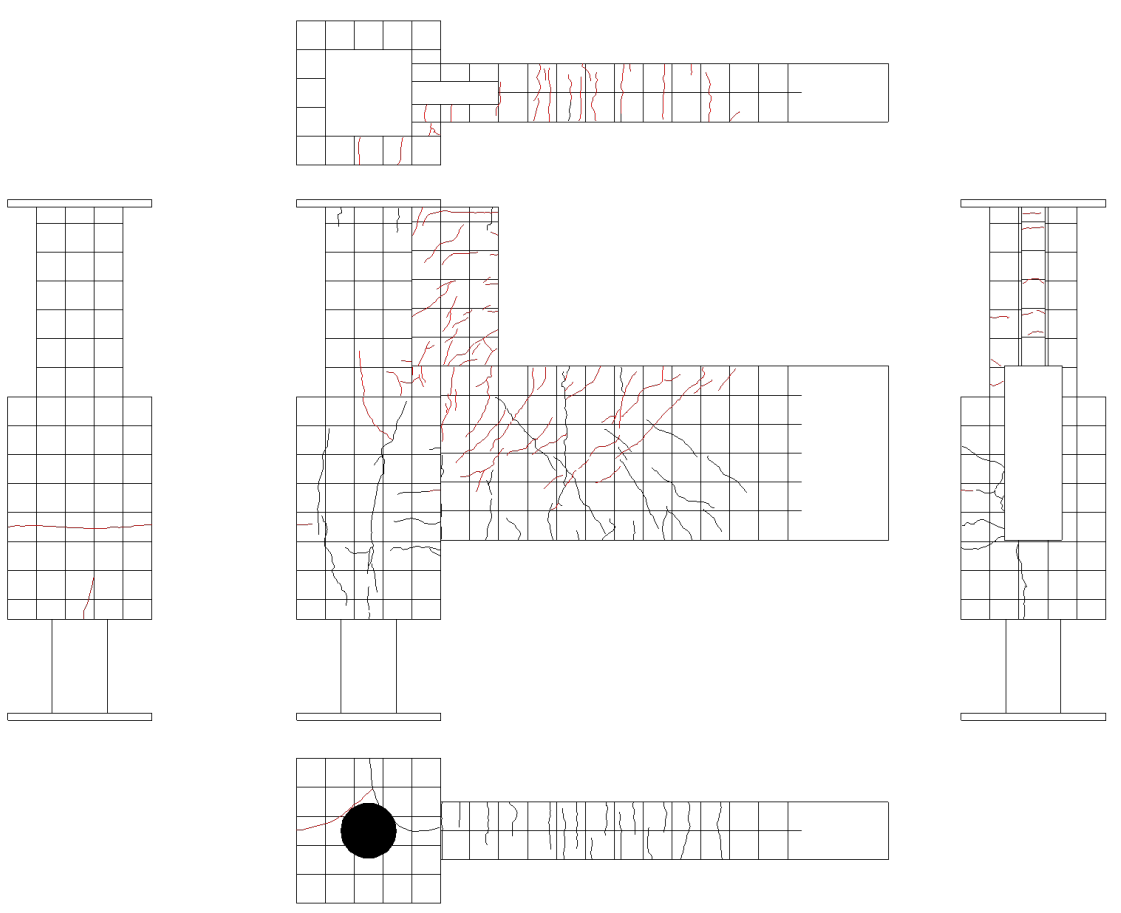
3. 76 試験体 B-1 ひび割れ状況 (3Cycle)
